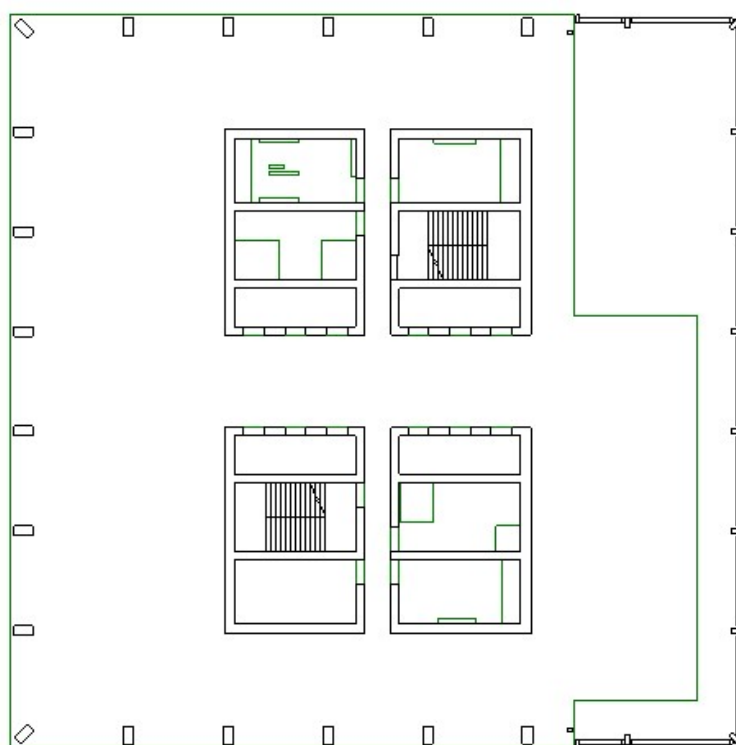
Pianta strutturale piano trentesimo (fuori scala).
